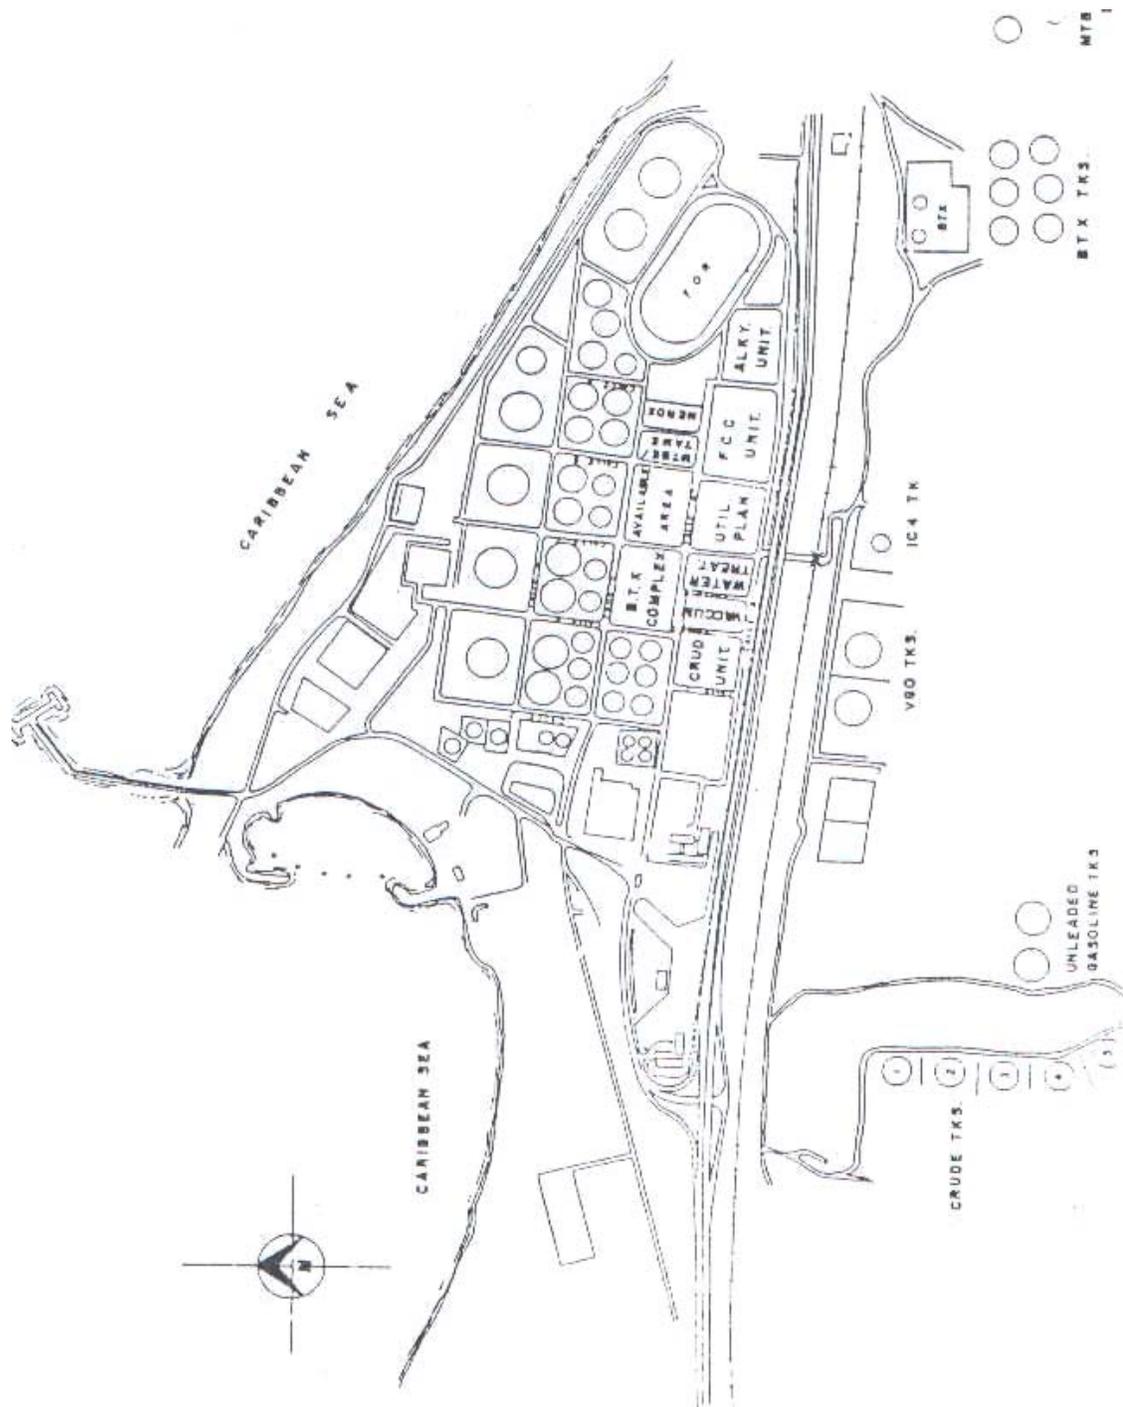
Plano de Sitio de la Refinería El Palito, ubicada en Puerto Cabello Edo. Carabobo.
